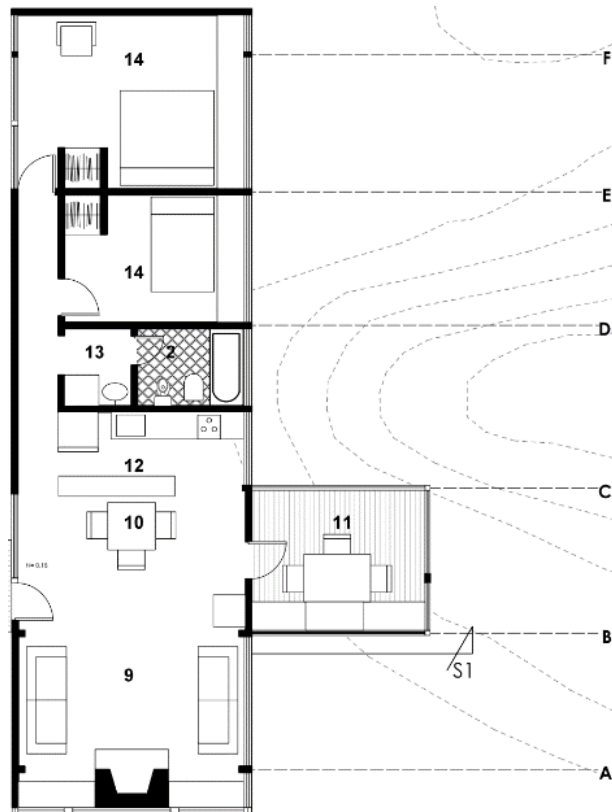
Planta baja, zonificación bloque 1. Fuente: Autor
